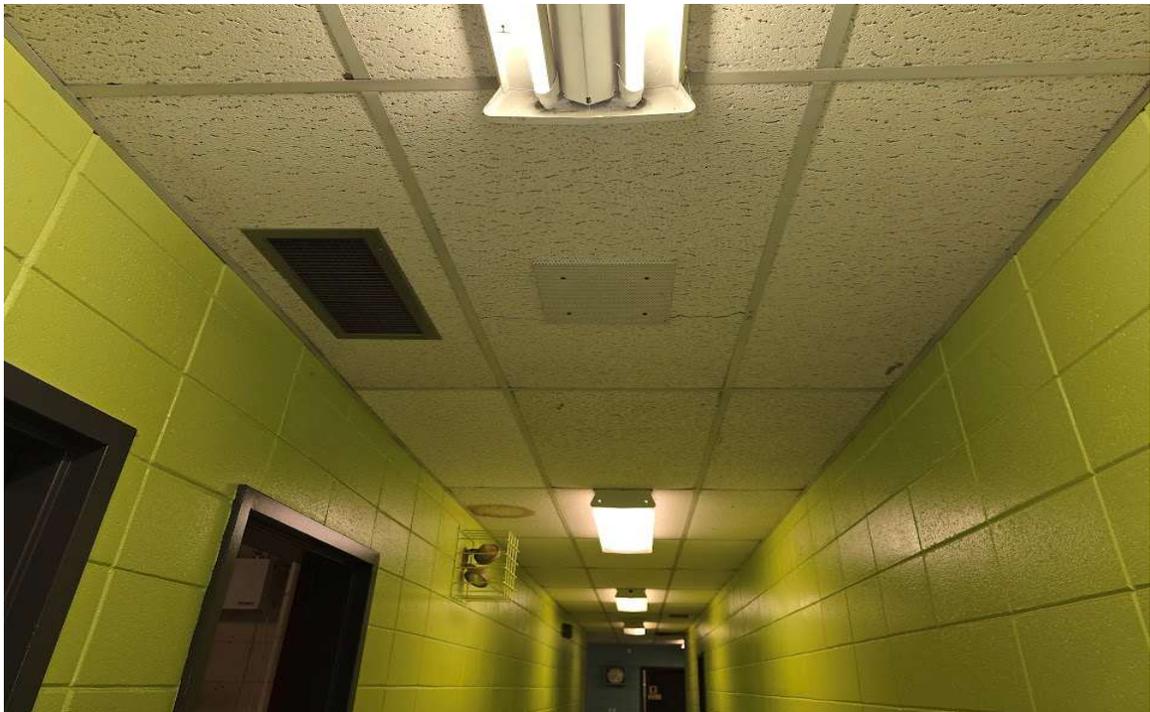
Ech-10. Faux plafond, couloir, matériaux n'est pas considéré comme MCA.
